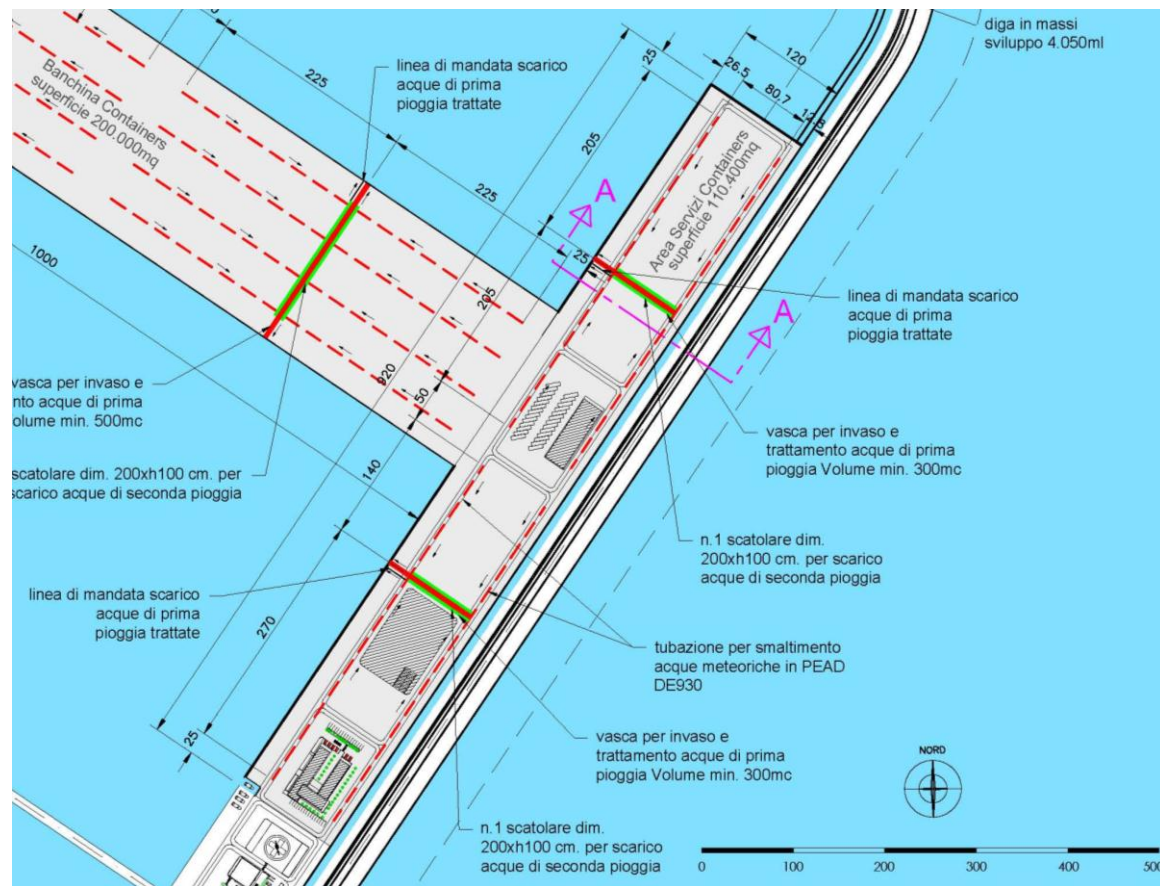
Banchina servizi - planimetria rete di smaltimento acque meteoriche
